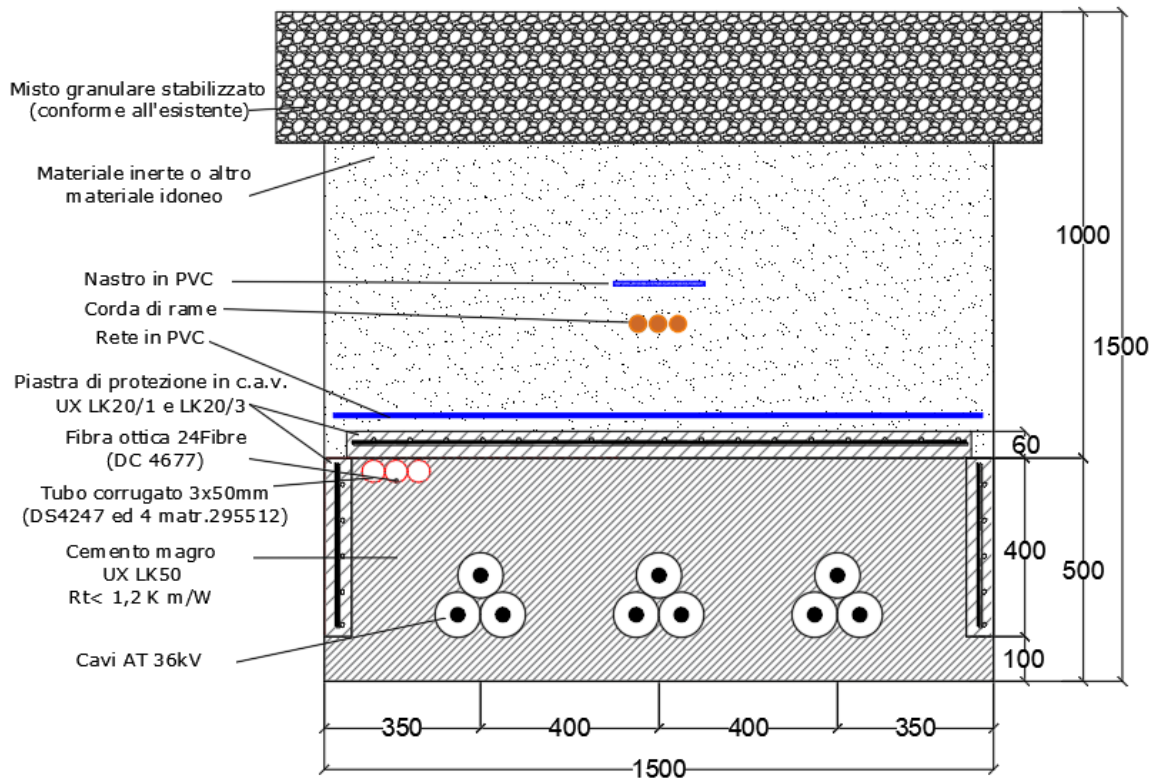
Sezione cavidotto di connessione AT a 36kV su strada sterrata
